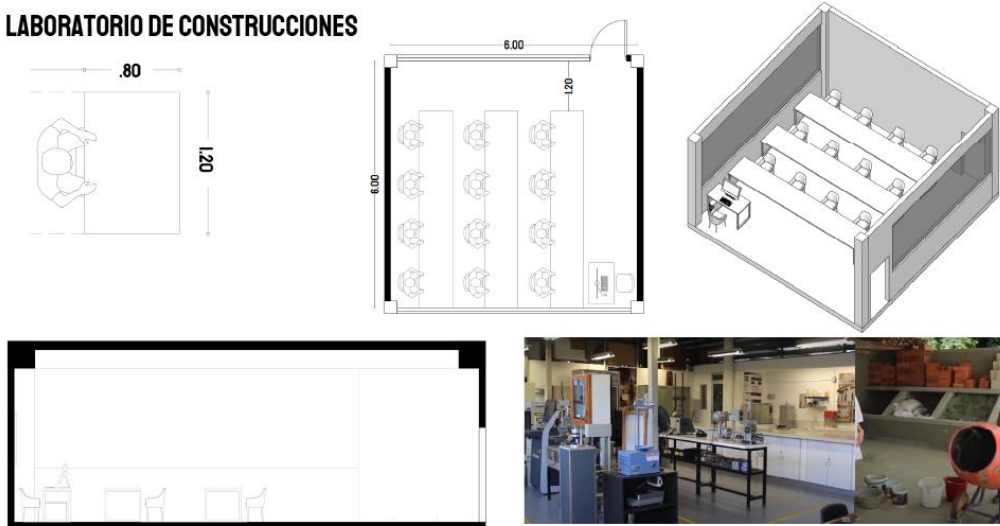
Propuesta laboratorio de construcciones. Ilustración del autor
